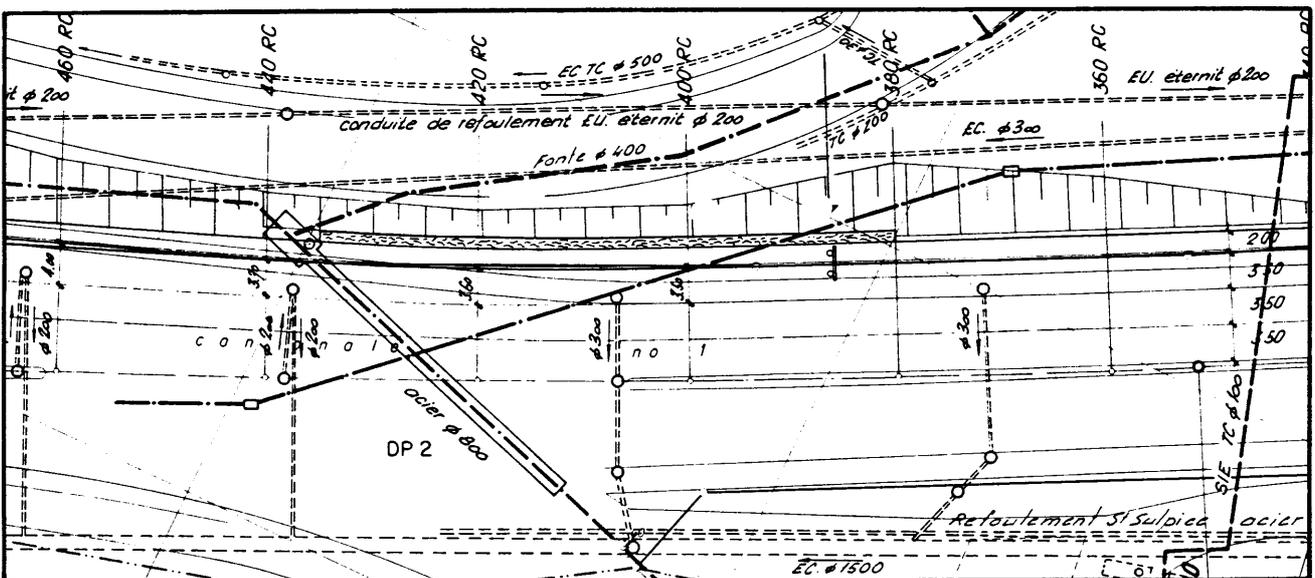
Plan de situation de canalisations et de conduites industrielles
